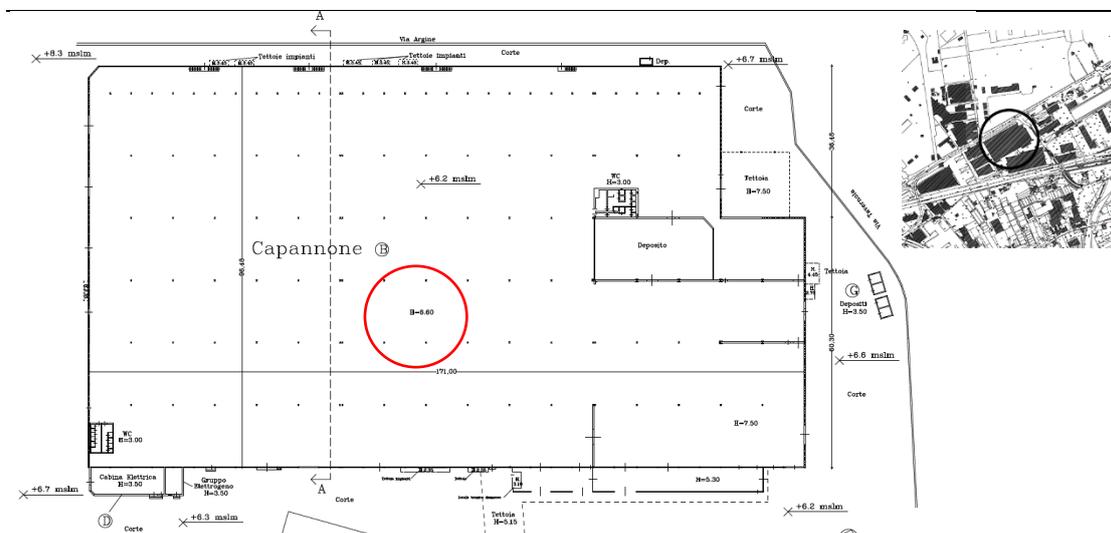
Planimetria del capannone principale con evidenziato l'altezza dell'edificio
